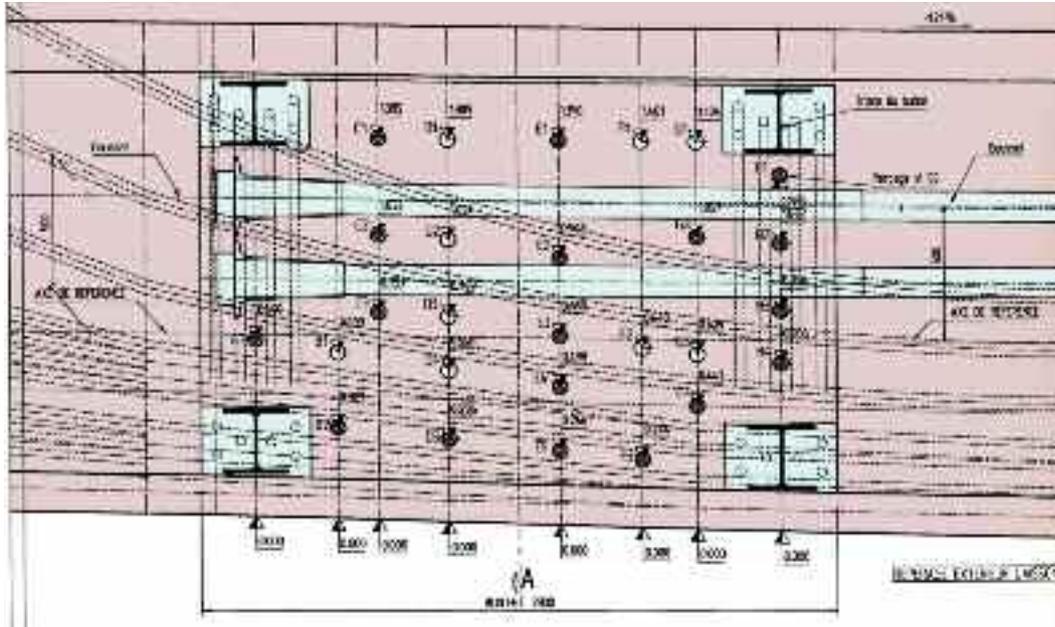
plan d'implantation des forages, dans l'âme d'une poutre-caisson, tenant compte de la position réelle des câbles de précontrainte
